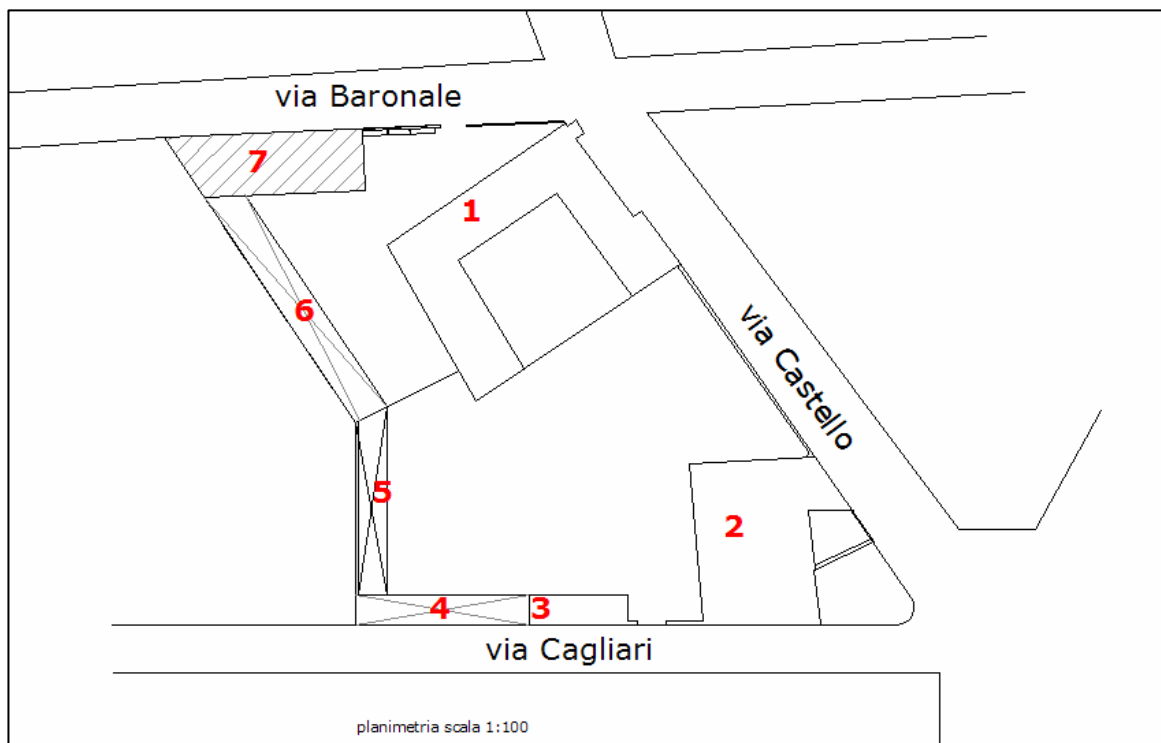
Planimetria del Complesso fortificato dopo il restauro
